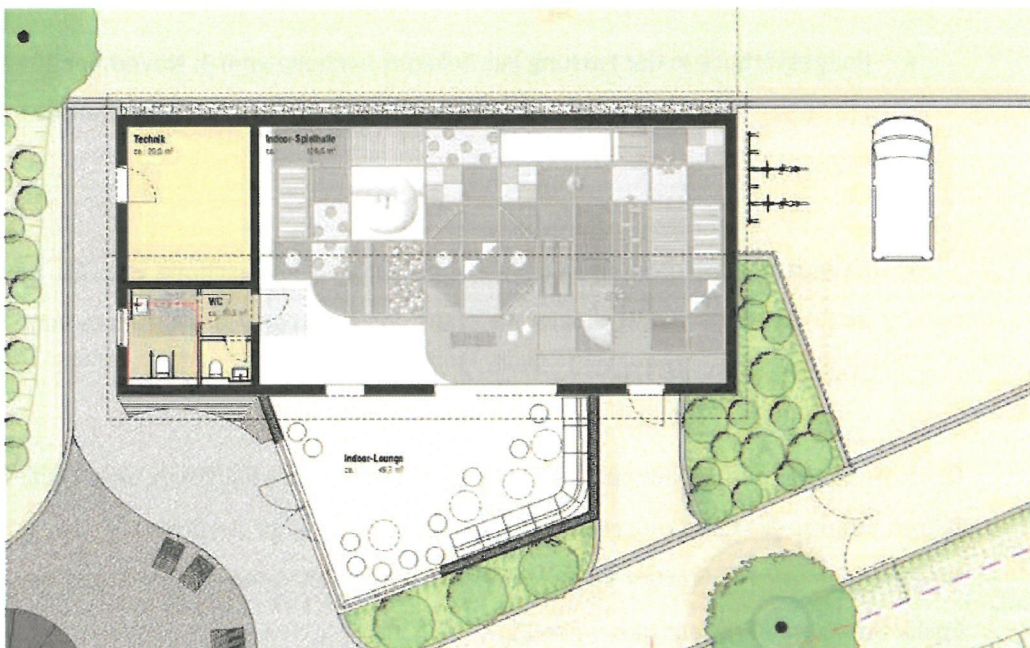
Entwurf Indoorsporthalle (Stand 07- 2021)
